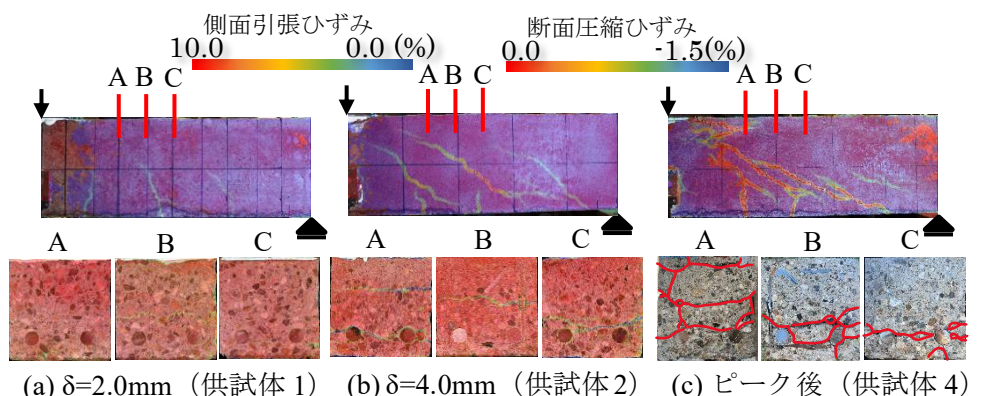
DIC による 3 次元的ひび割れ発生・進展状況
